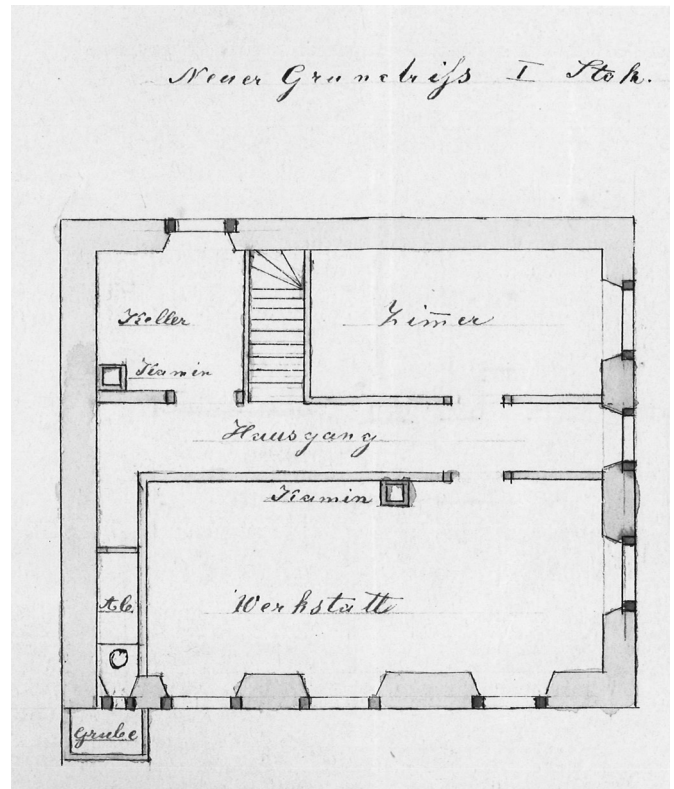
Kirchstraße 8, Grundriß Erdgeschoss, neue Planung von 1896.
